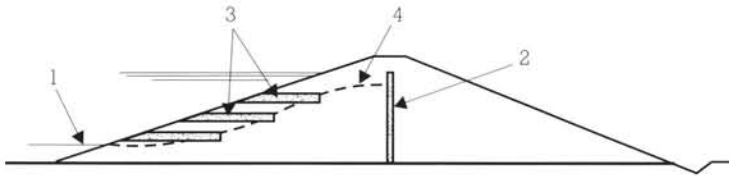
Schéma du rabattement de la nappe du remblai par des drains horizontaux en vidange rapide.
